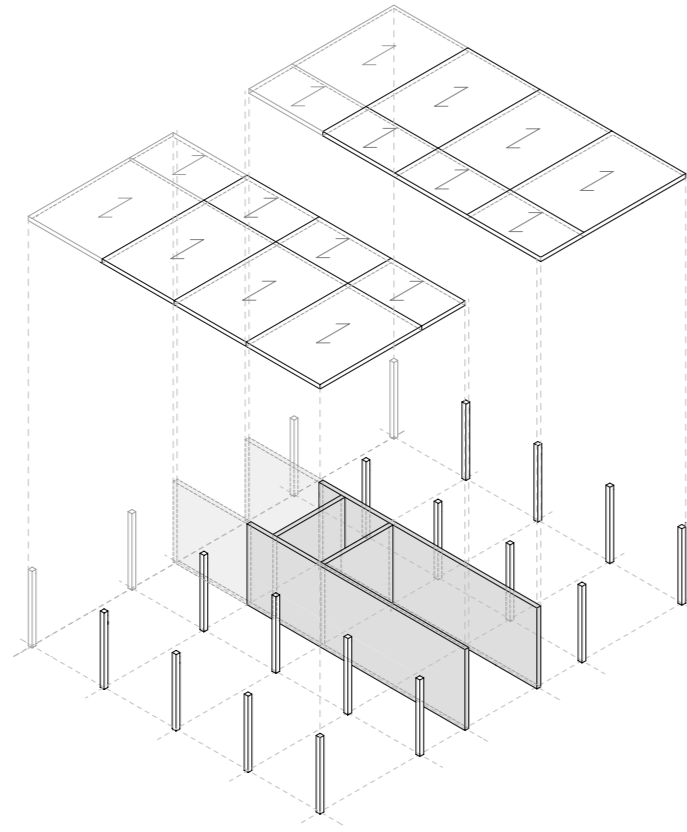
Holzskelettbau mit aussteifenden Betonkern (eigene Darstellung)
